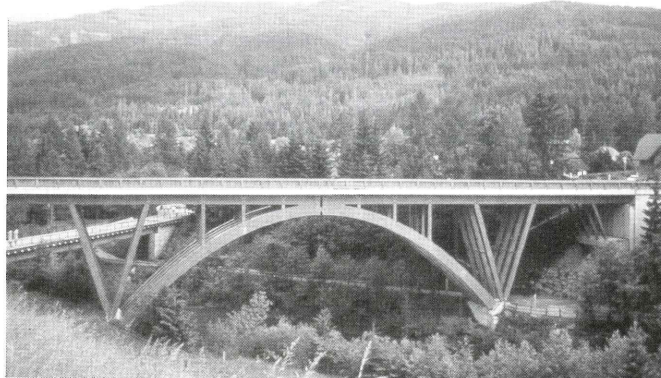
Straßenbrücke über die Muhr, St Georgen/ Österreich, Dreigelenkbogen aus Brettschichtholz Lärche mit 45m Spannweite, Fahbahnplatte aus vorgefertigten Stahlbetonplatten (Verbindung Stahlbeton/ Holz über eingeklebte Sahlstäbe), Brückenbauklasse 60/30 (s. auch Pischl u. a. in [24]), (Foto: Archiv Arge Holz, Düsseldorf)
